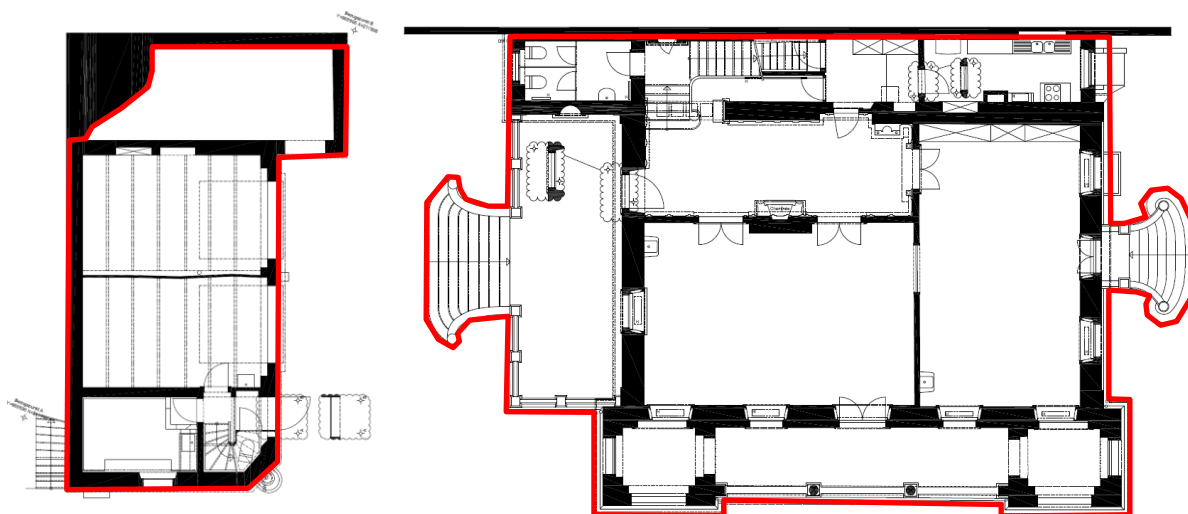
Erdgeschossgrundrisse und Fussabdruck Remise links und Villa rechts. Rot umrandet die Baurechtsfläche.
